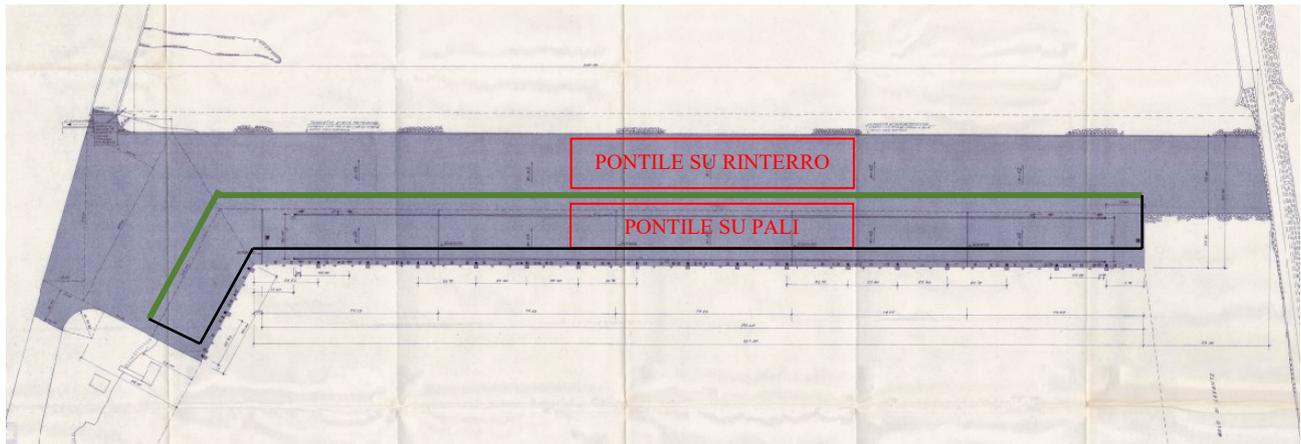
Pianta generale banchina – Giunto di dilatazione longitudinale
